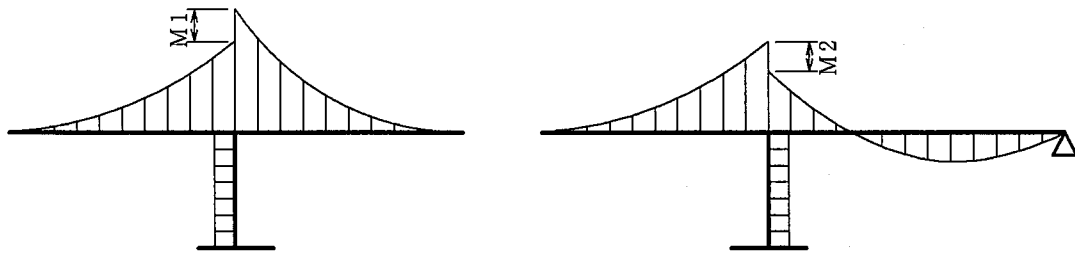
施工時の構造系変化の例（曲げモーメント図）
